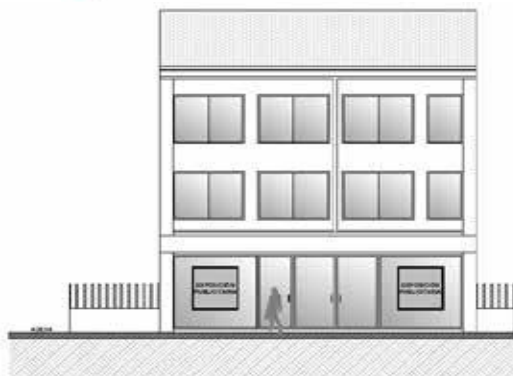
Tipo F- Fachada o Cerramiento. - Publicidad o propaganda exterior en fachada frontal, lateral o cerramiento
